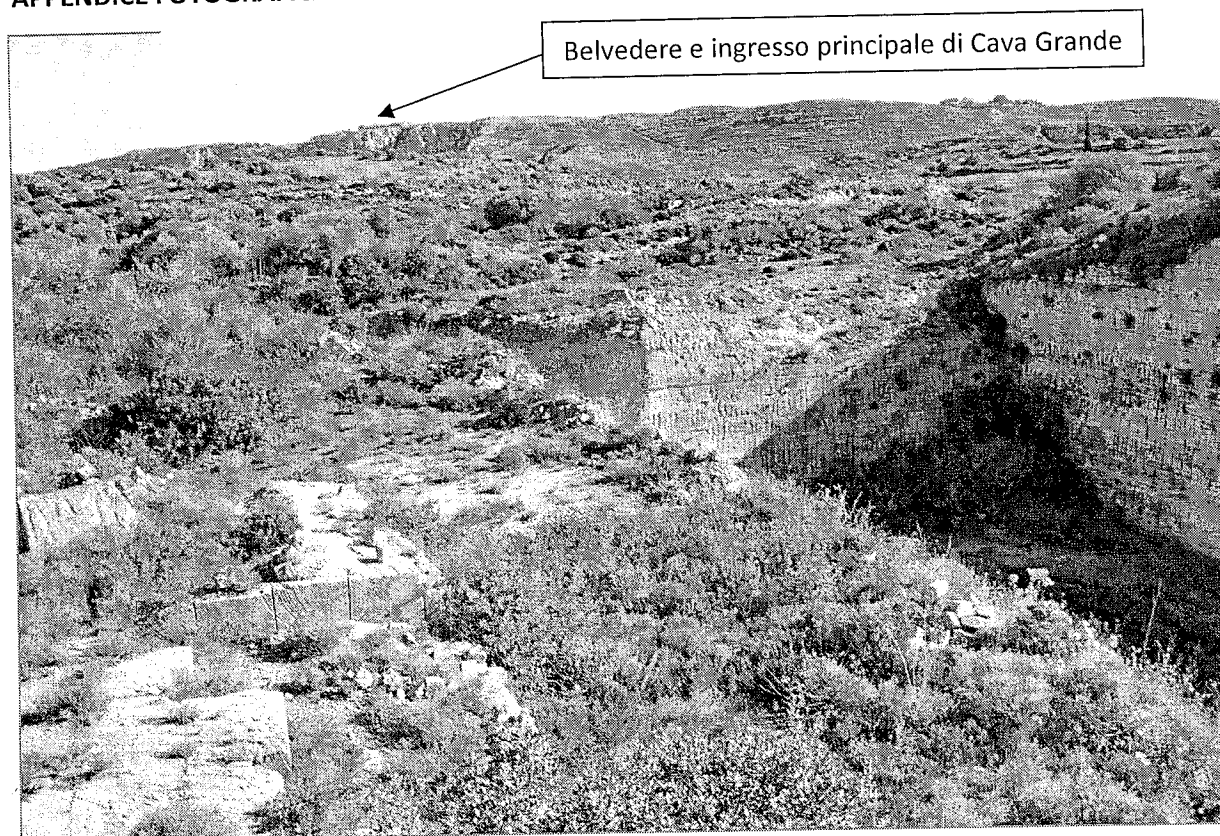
, il belvedere ingresso della riserva visto dalla cava dell'intervento.
